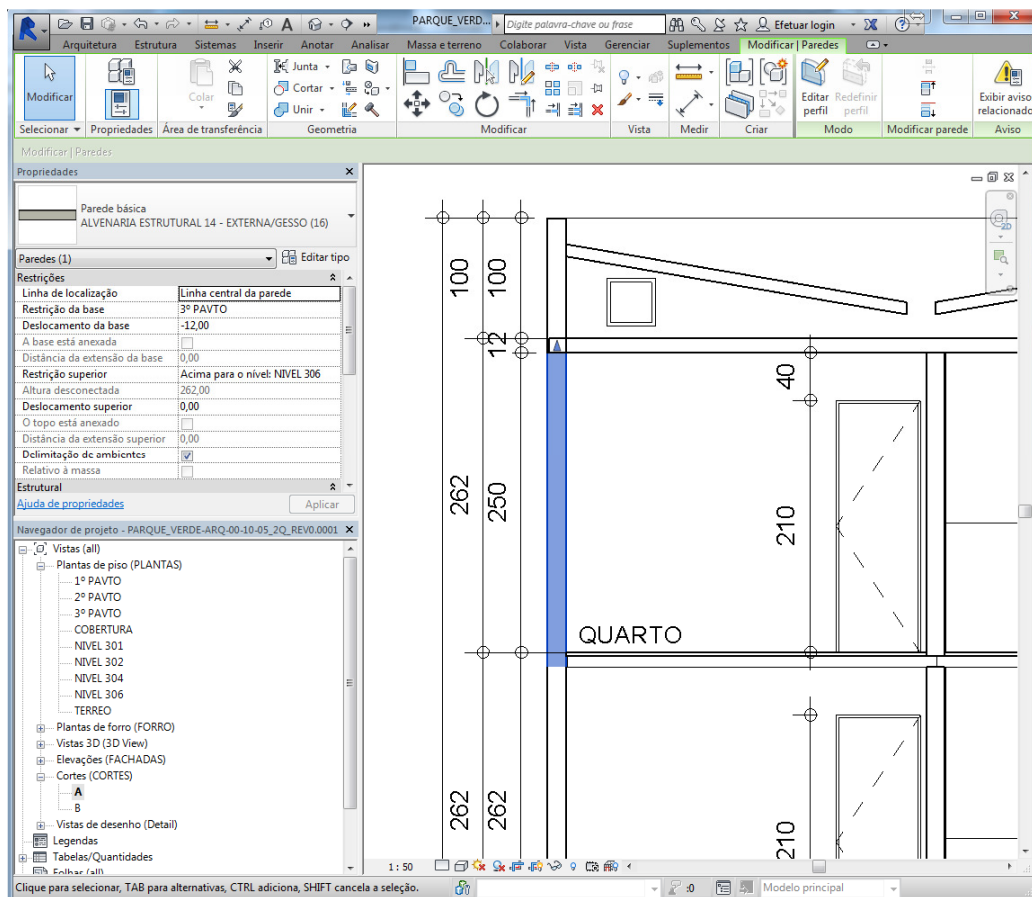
Destaque em rosa da área lateral de um elemento parede
